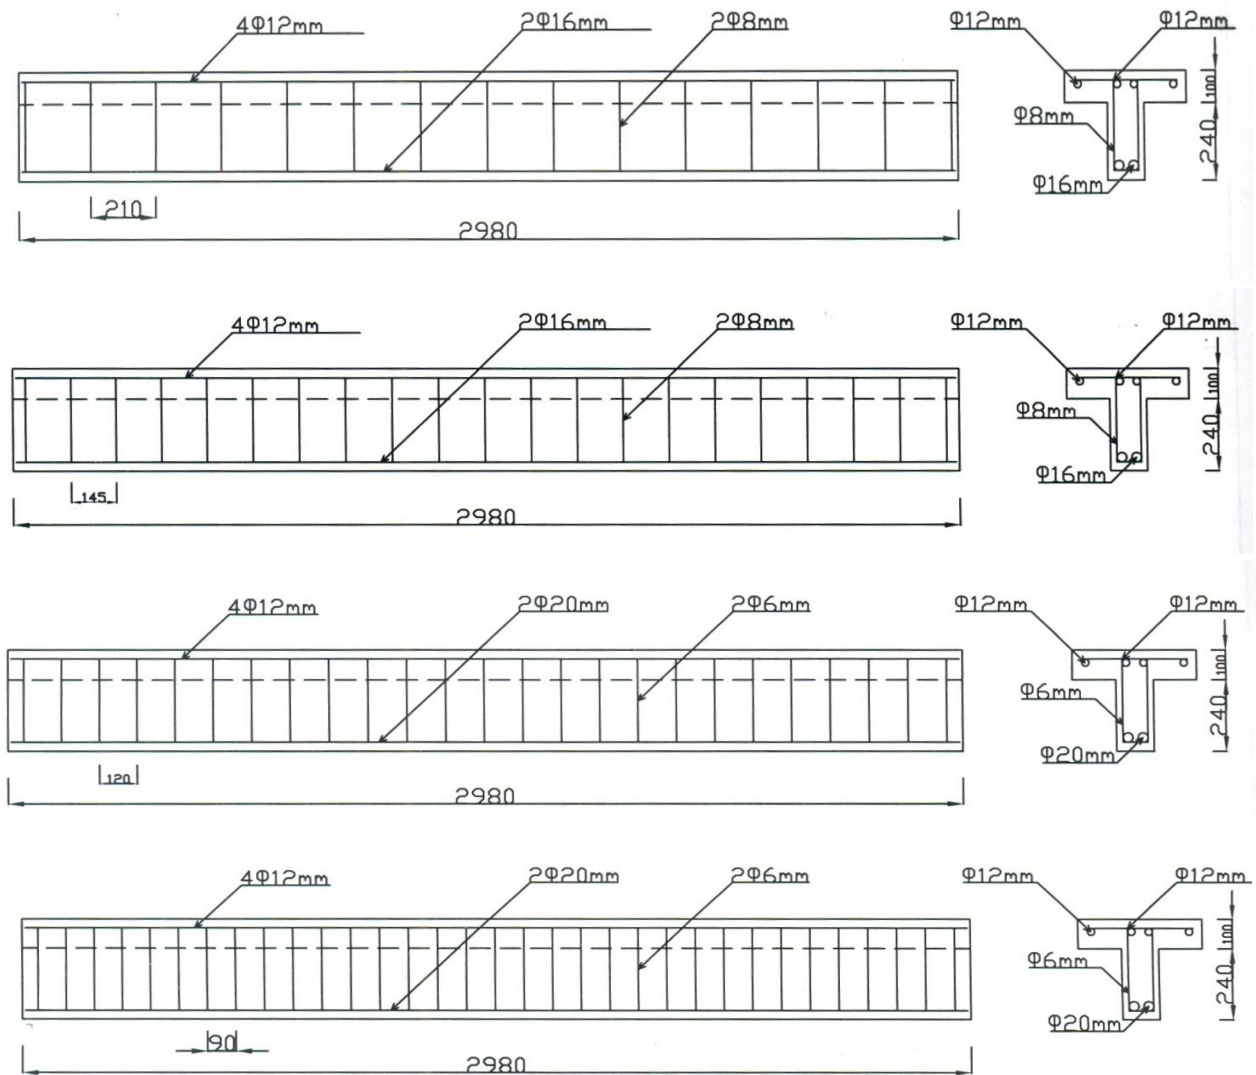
Схема армирования балок подгруппы TS1, TS2, TT1, TT2
